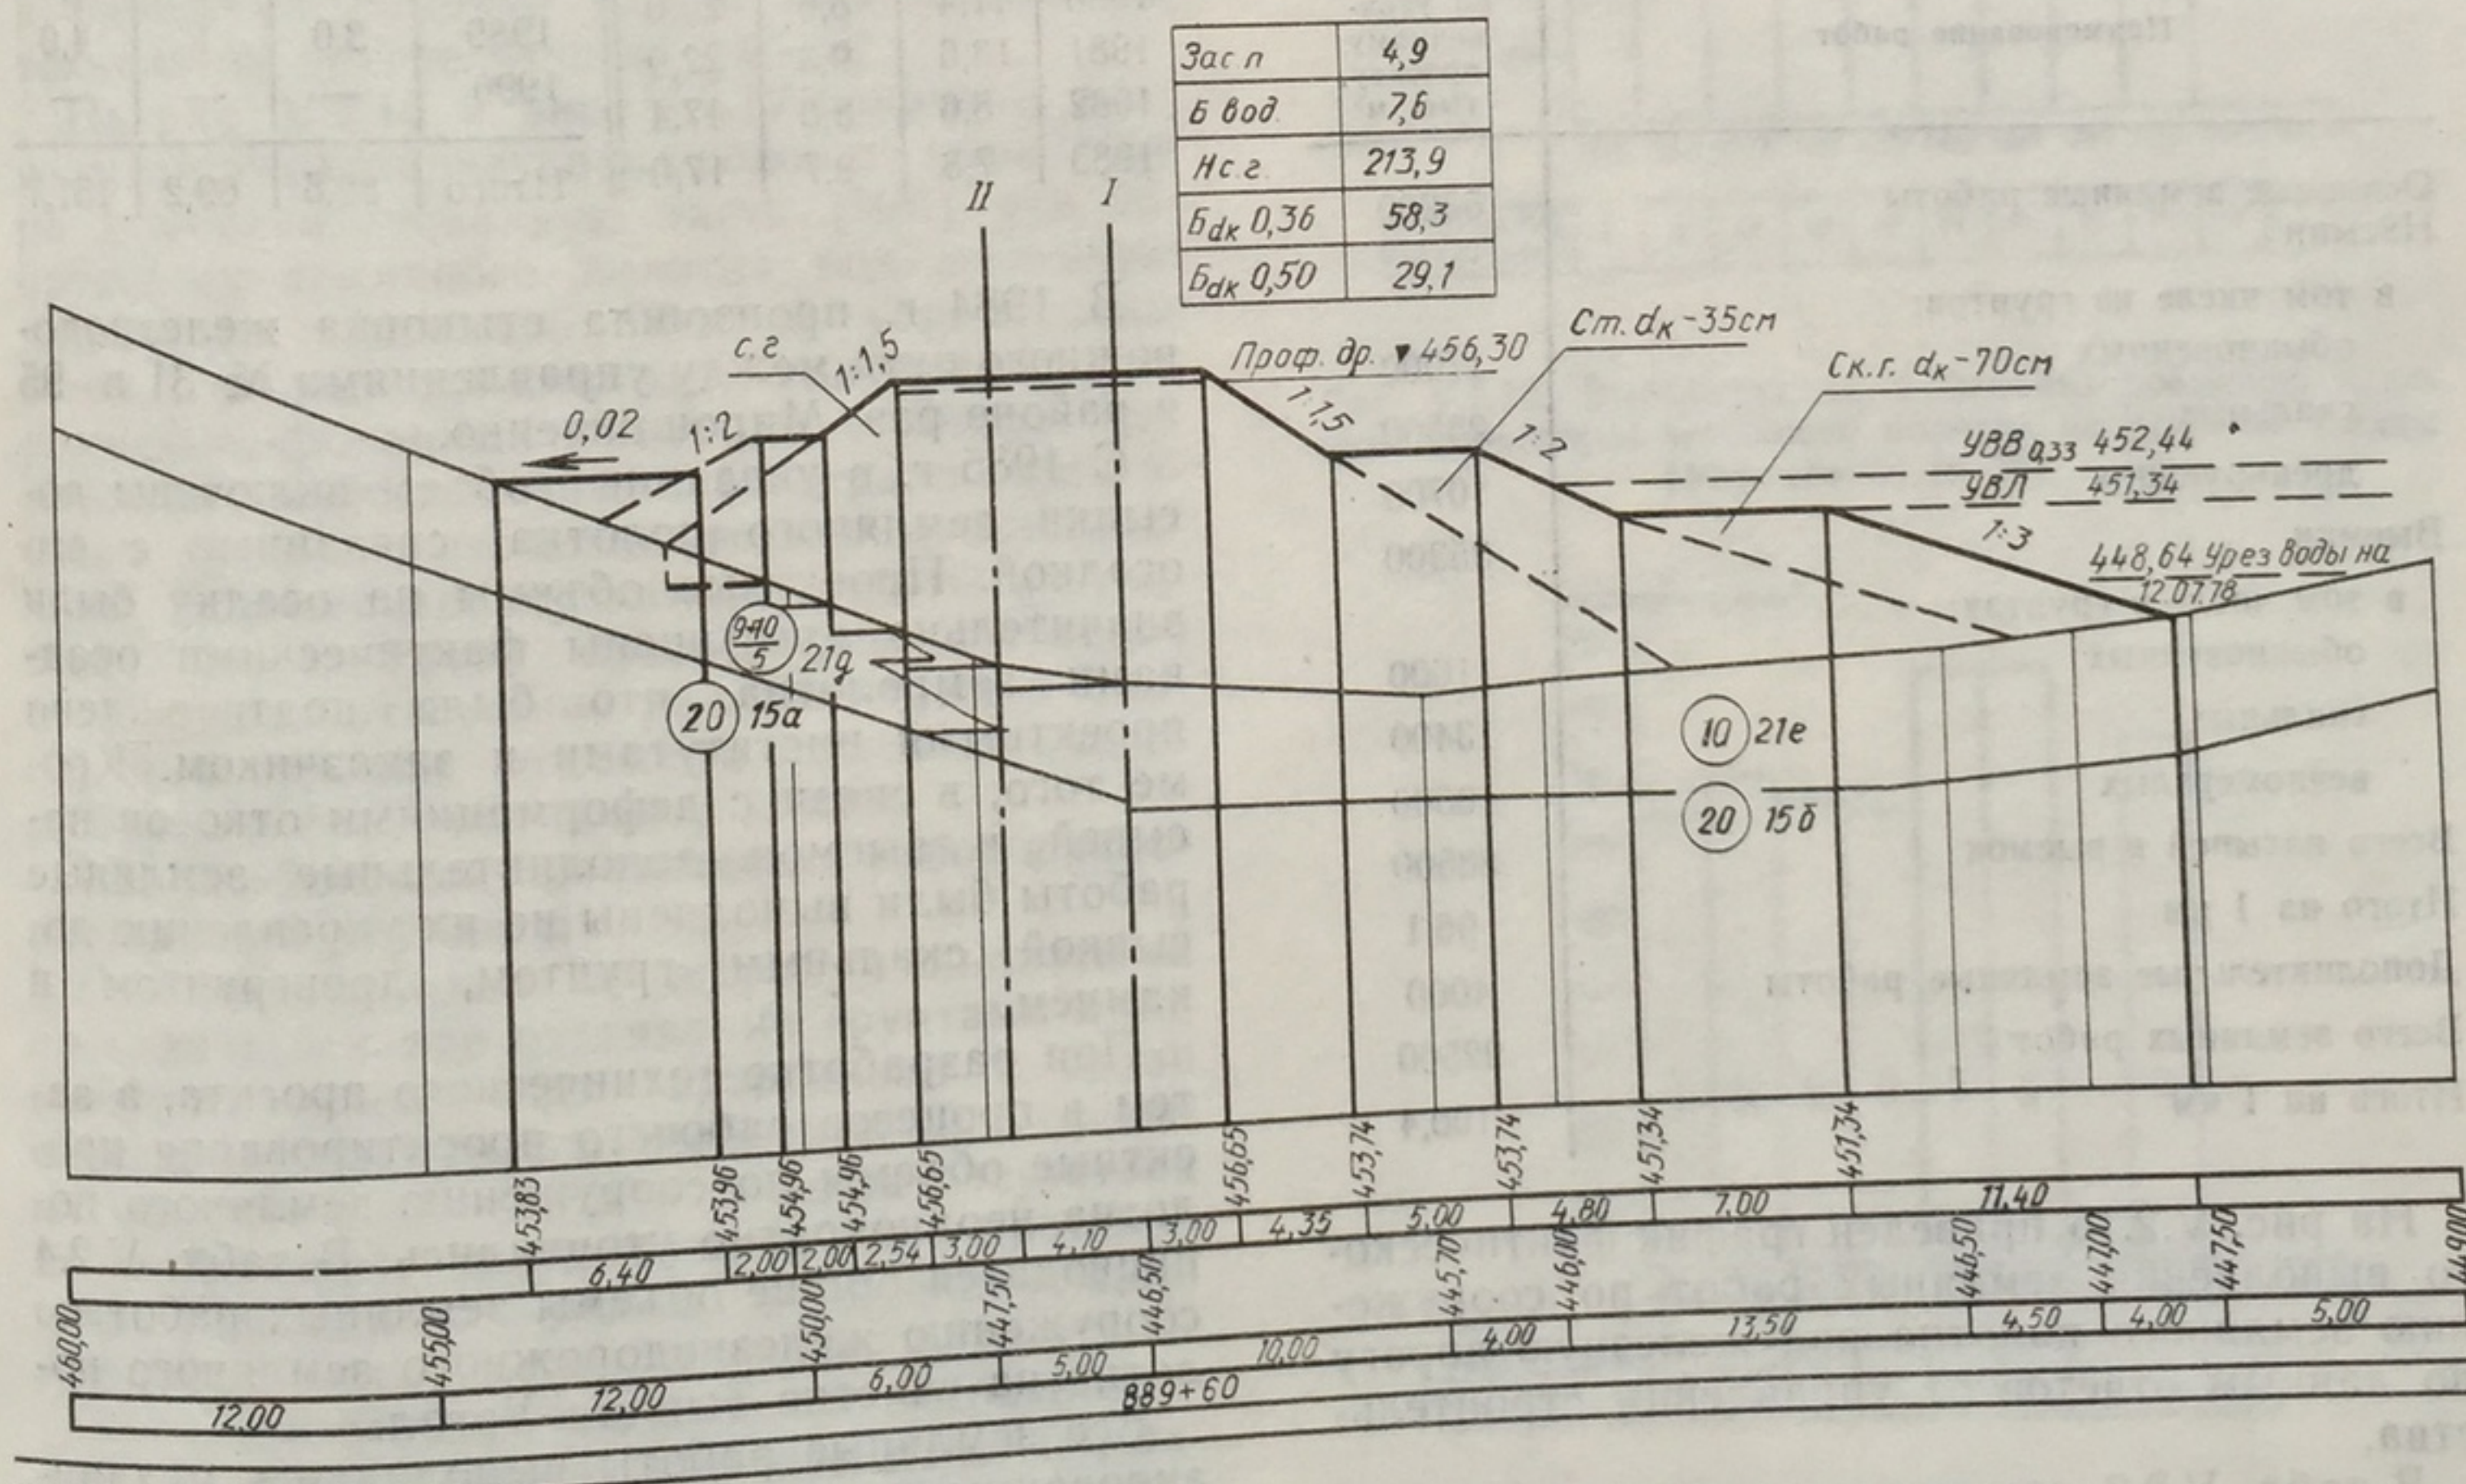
Поперечный профиль насыпи у подошвы склона и подмываемый р. Туяна на 2510 (875) км
